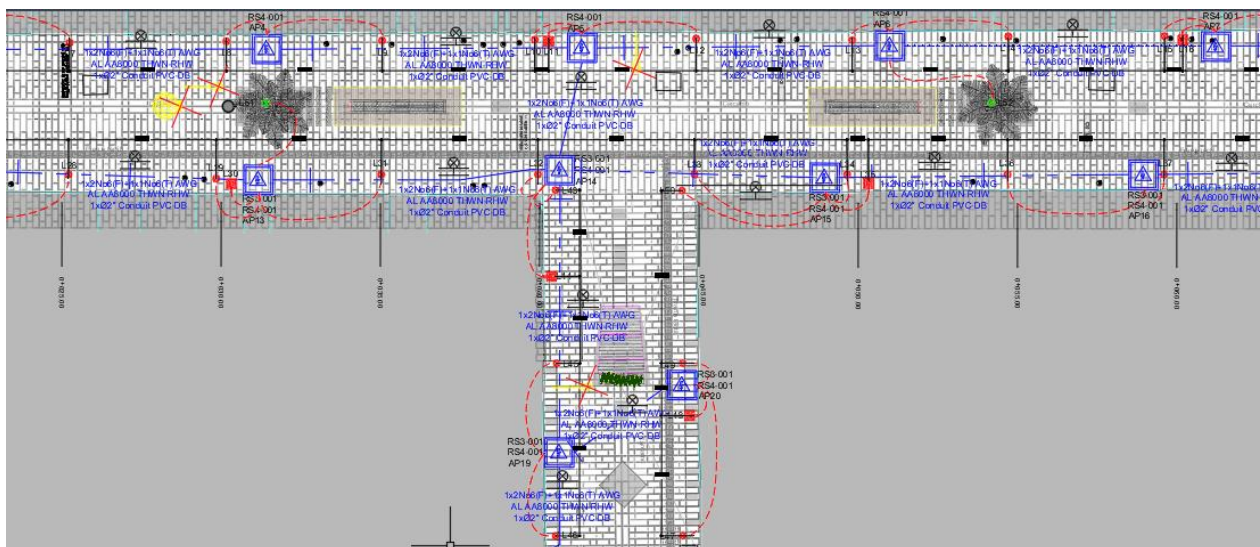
Redes eléctricas de alumbrado público Calle de la Zapatería Rionegro.
